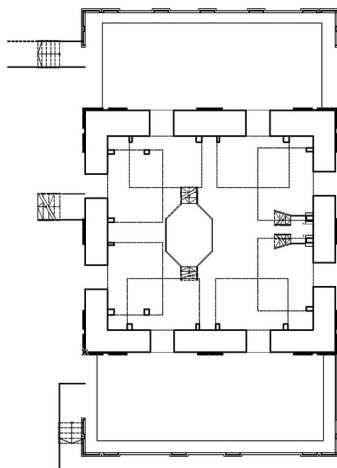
Zamosc_Grundriss_Obergeschoss.png
